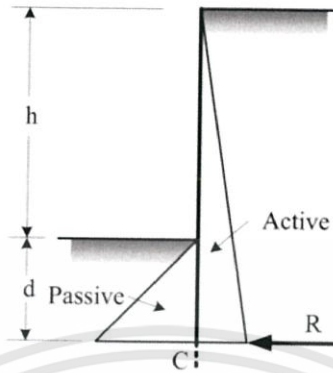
ความต้านทานด้านข้างที่กระทำต่อ Cantilever Sheet Pile Wall
